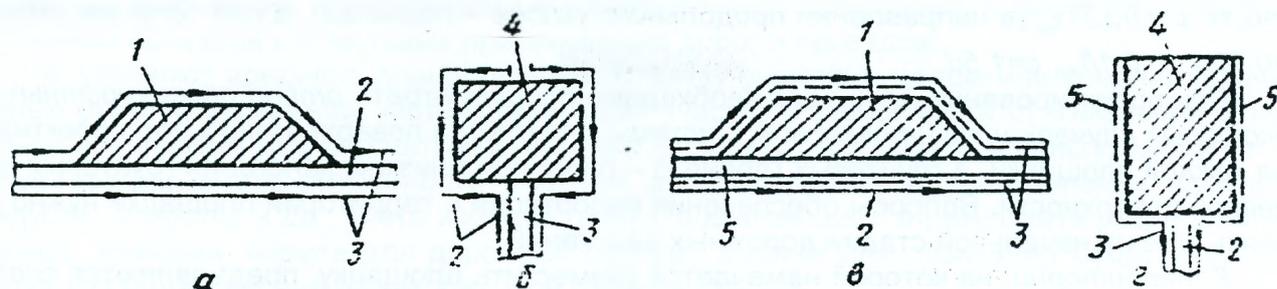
Схемы расположения канав и дрен неглубокого заложения у площадок и отдельных сооружений: а, б – канавы; в, г – дрены неглубокого заложения; 1 – площадка; 2 – дорога; 3 – канава; 4 – сооружение; 5 – дрена
